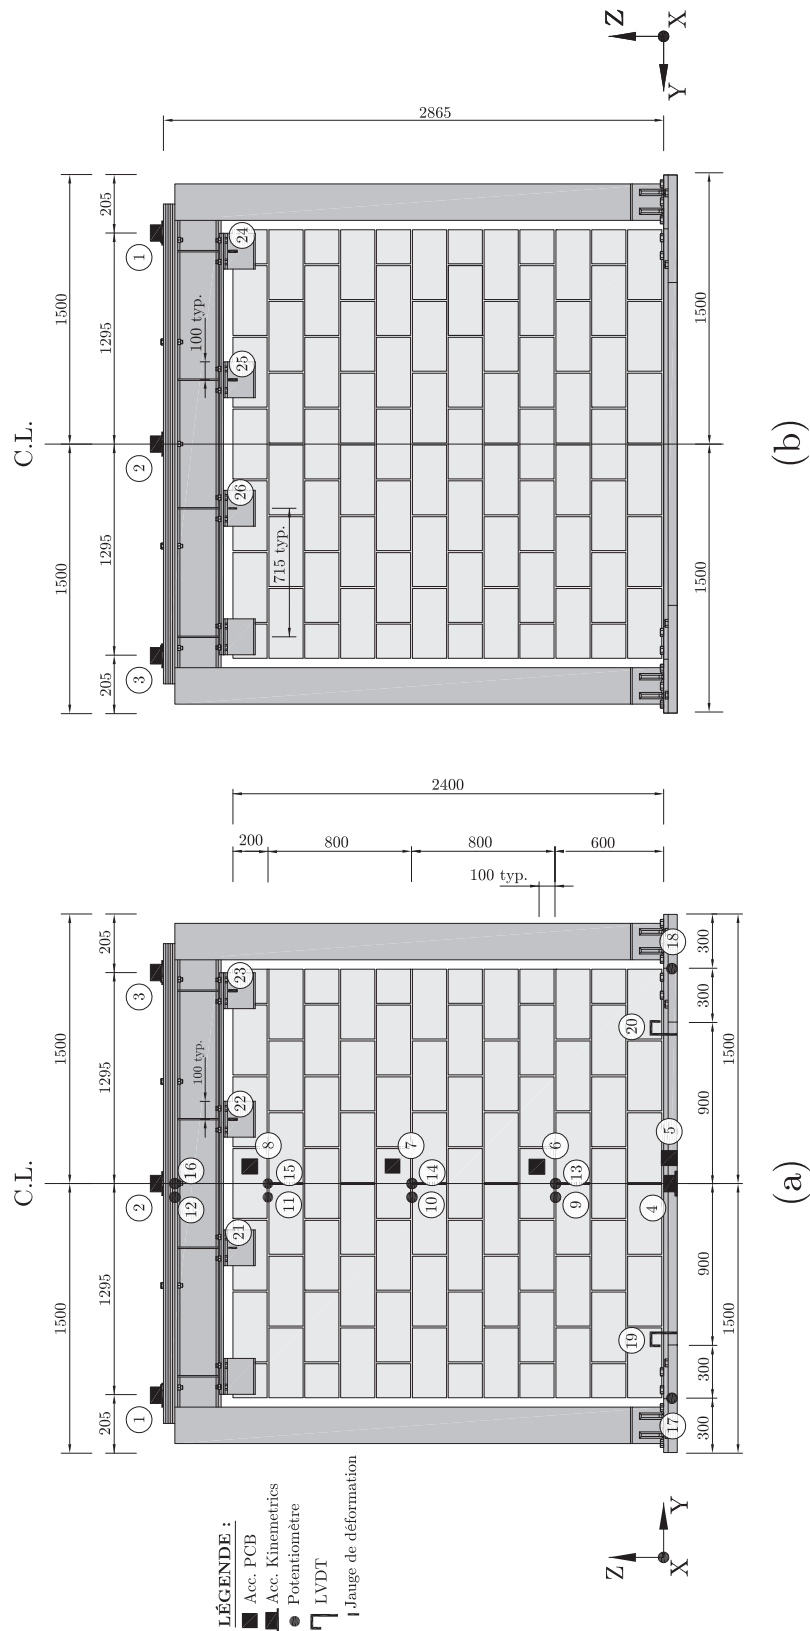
Plan de l'instrumentation du 1<sup>er</sup> mur (a) façade avant du mur (b) façade arrière du mur
